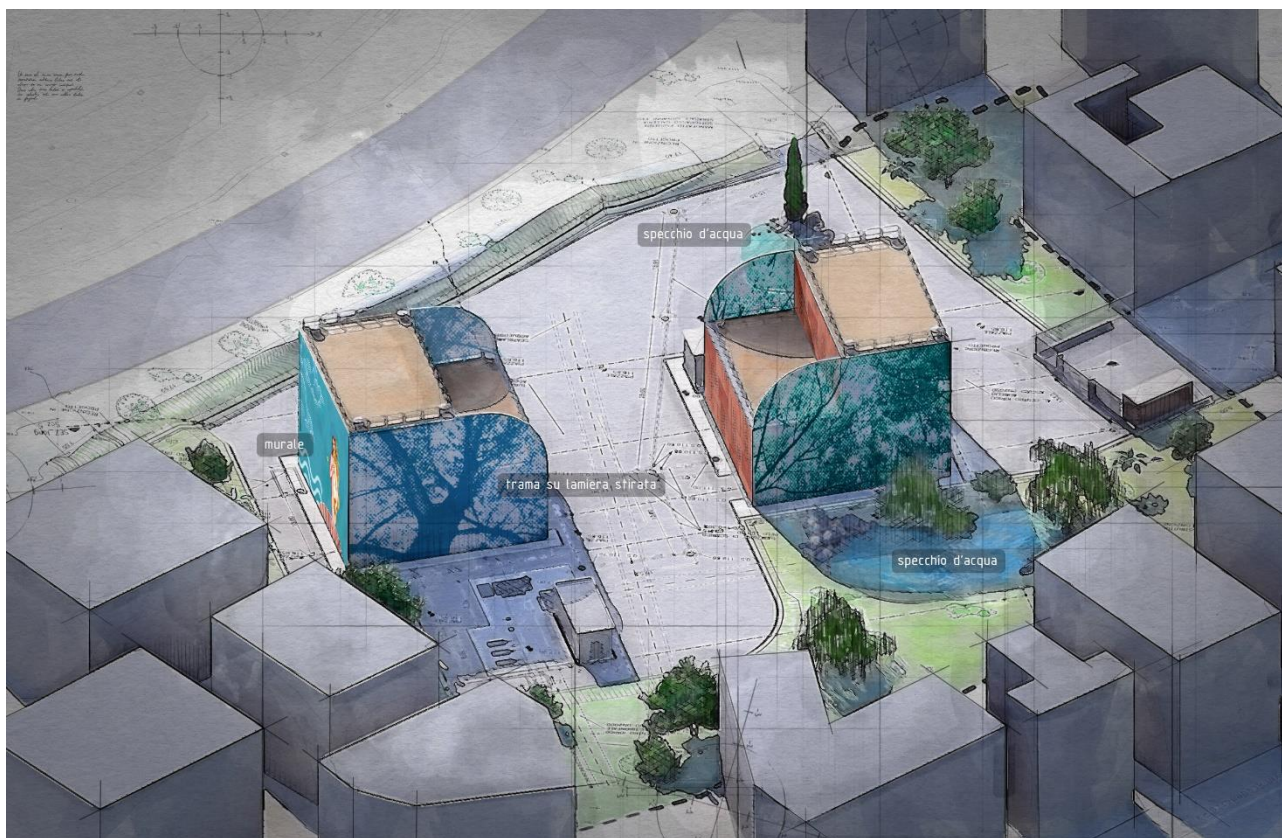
Concept progettuale del Nuovo Centro idrico Pineta Sacchetti – vista tridimensionale lato nord-ovest
